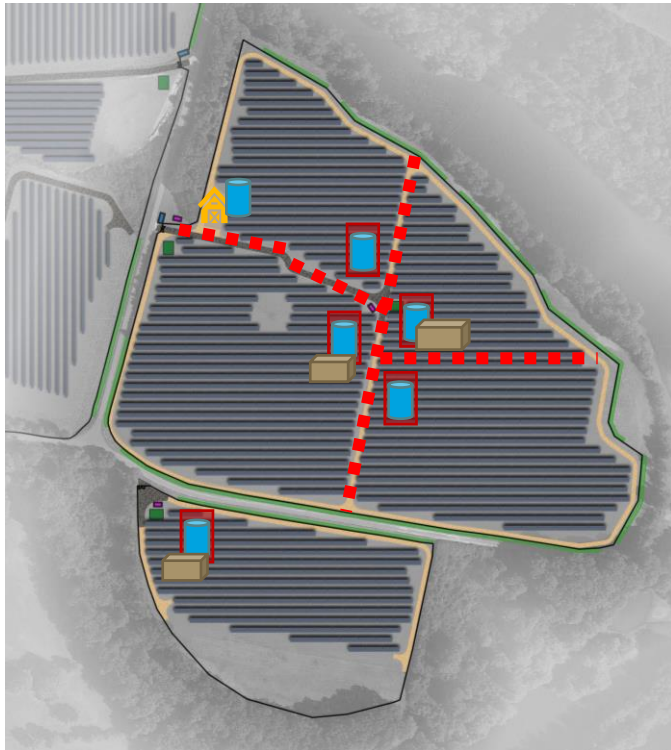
Plan d'implantation des zones de pâturage sous les panneaux fixfills bi-pieux sur la zone sud ovin (Source : TotalEnergies)
